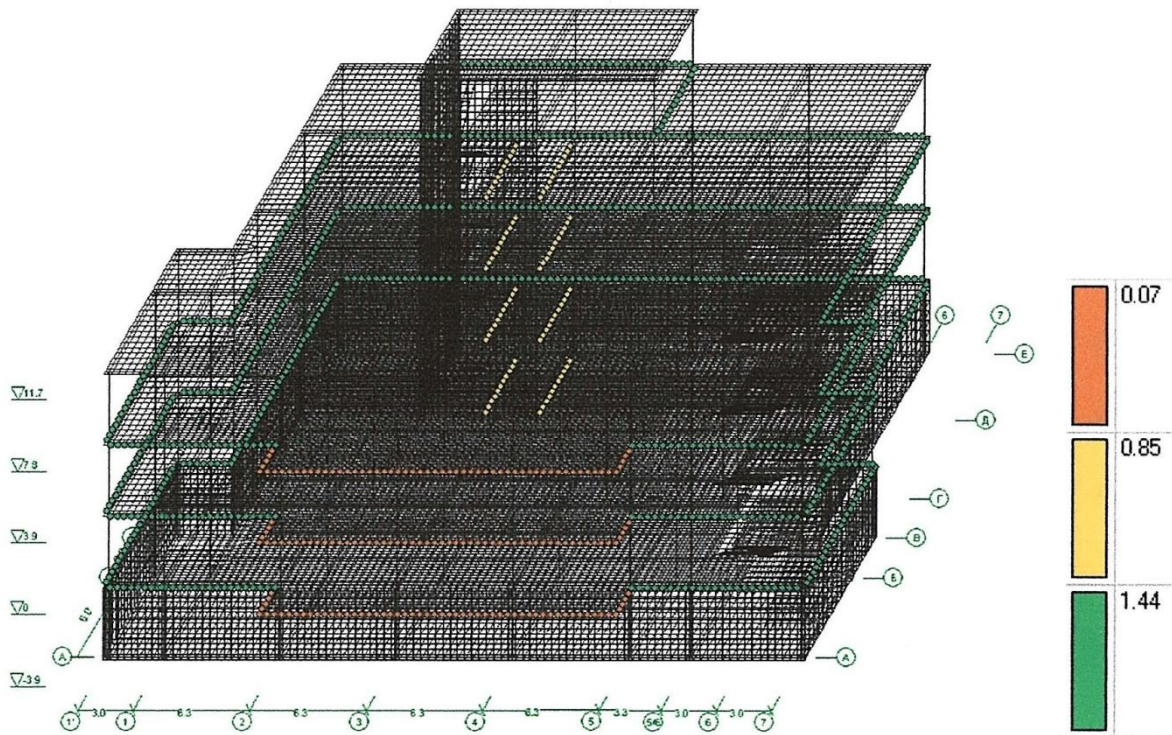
Схема завантаження 2 – Зосереджені сили від стін, сходів, т
